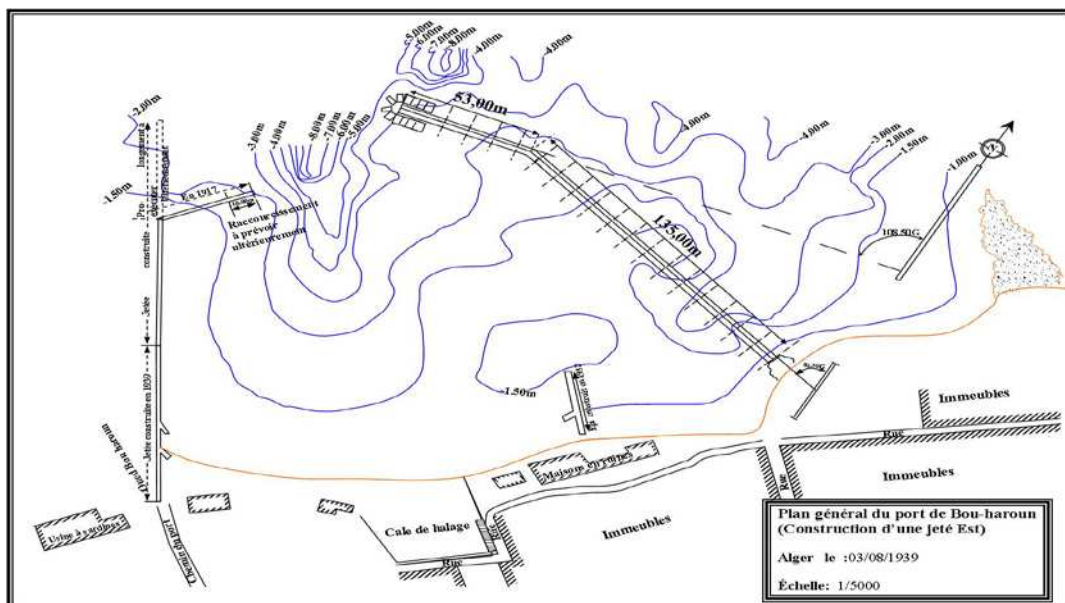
Plan général du port de Bouharoun (construction d'une jetée Est en 1939) (D.T.P,2007).
